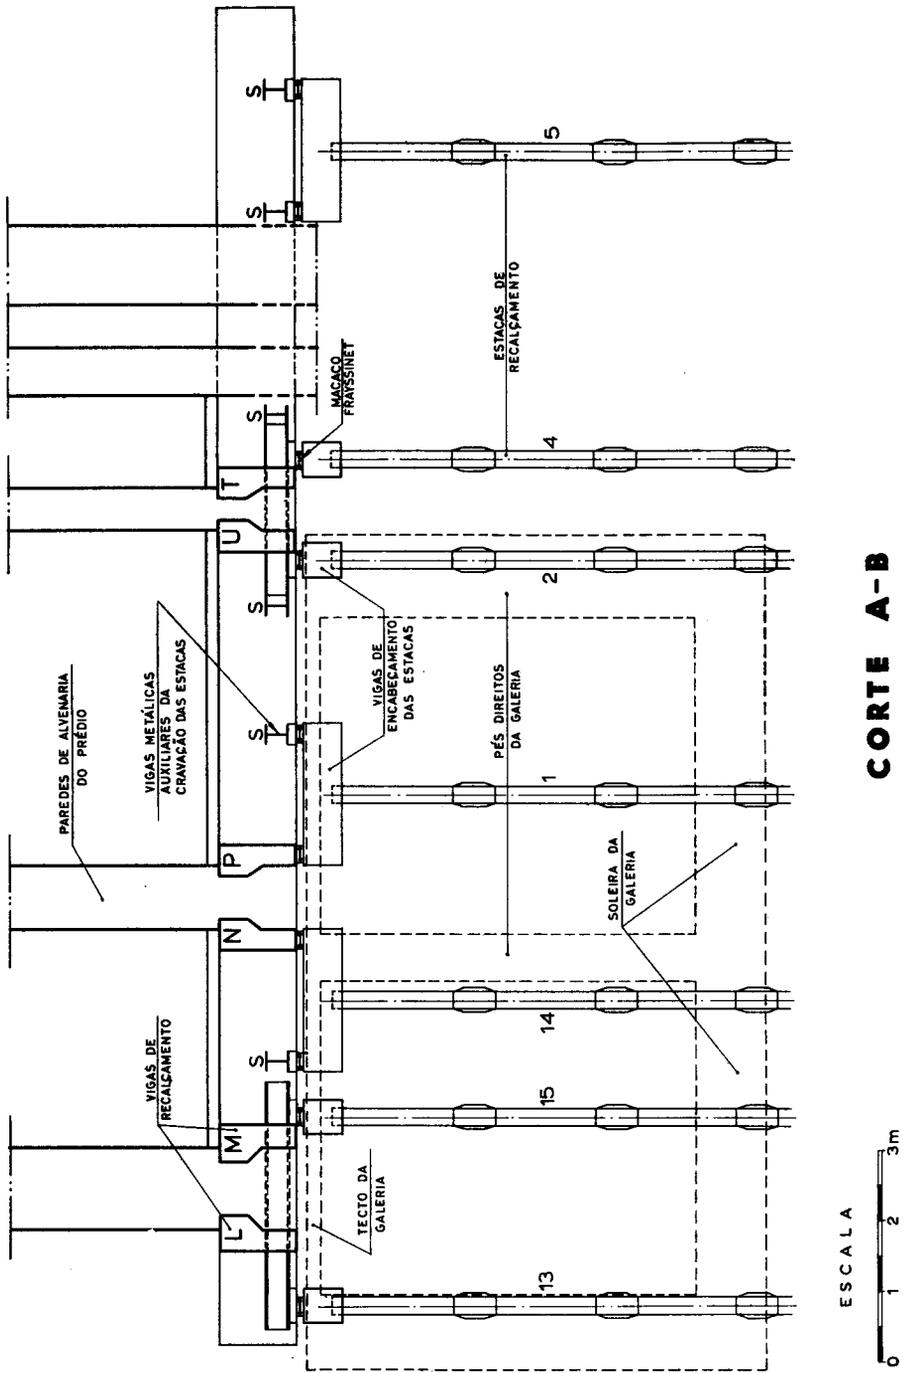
Corte A-B do sistema de recalçamento indicado em planta na Fig. 29
